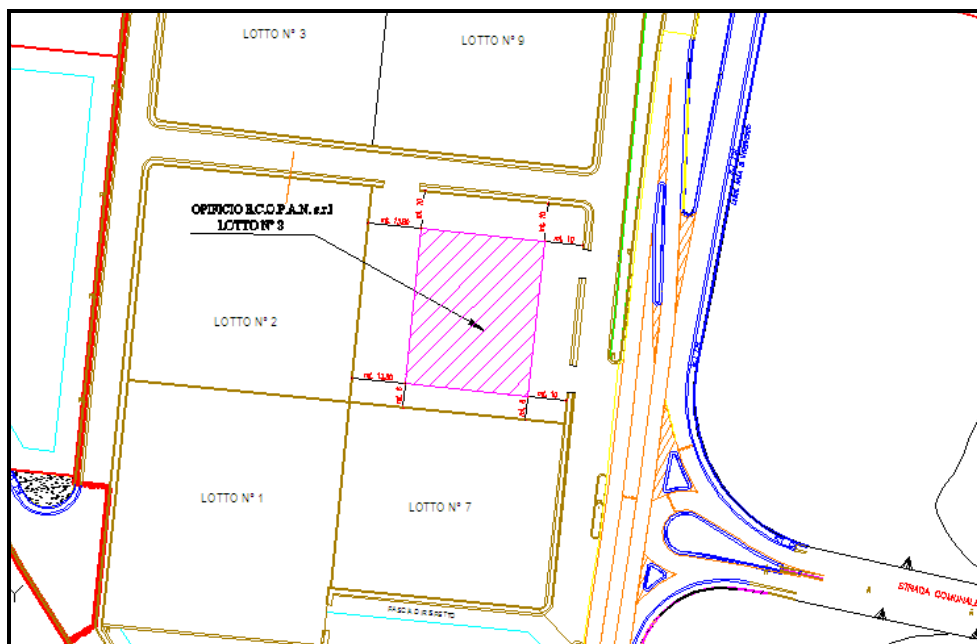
Stralcio Planimetrico dell'area P.I.P.
